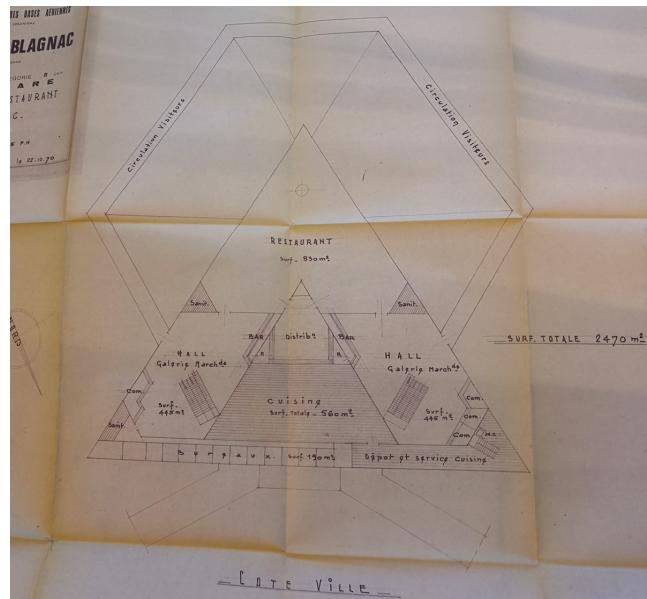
Plan provisoire niveau supérieur départ, aérogare de Toulouse-Blagnac 2, architectes : Montier, 1973
